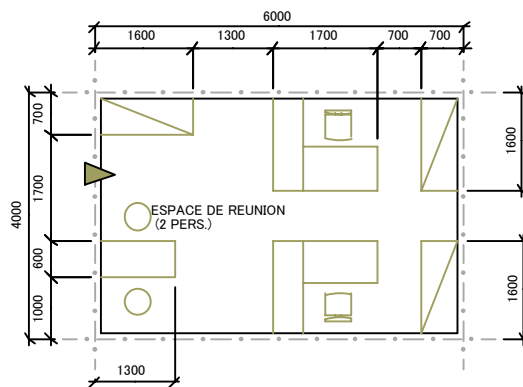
Plan planimétrique de la salle des statistiques du marché/bureau
